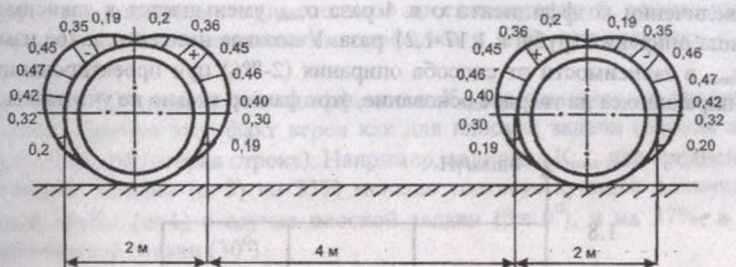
Эпюры радиального давления грунта на трубы двухниточной укладки.
